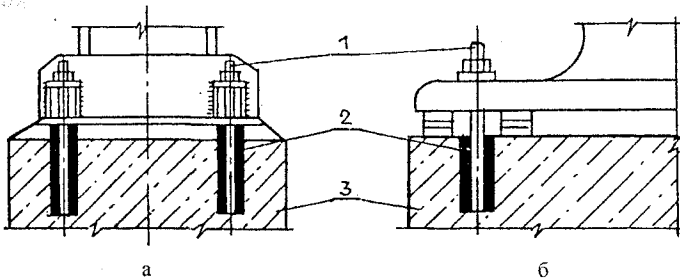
Крепление строительных конструкций (а) и технологического оборудования (б) к фундаментам: 1 – гладкий анкерный болт; 2 – клеевой слой; 3 – фундамент
